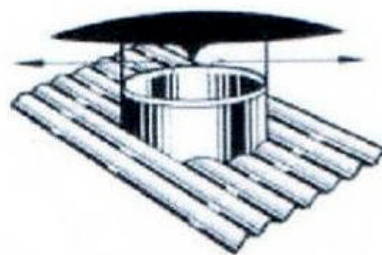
Equipamento para ventilação proposta (adaptado de TECVENT, 2006)
